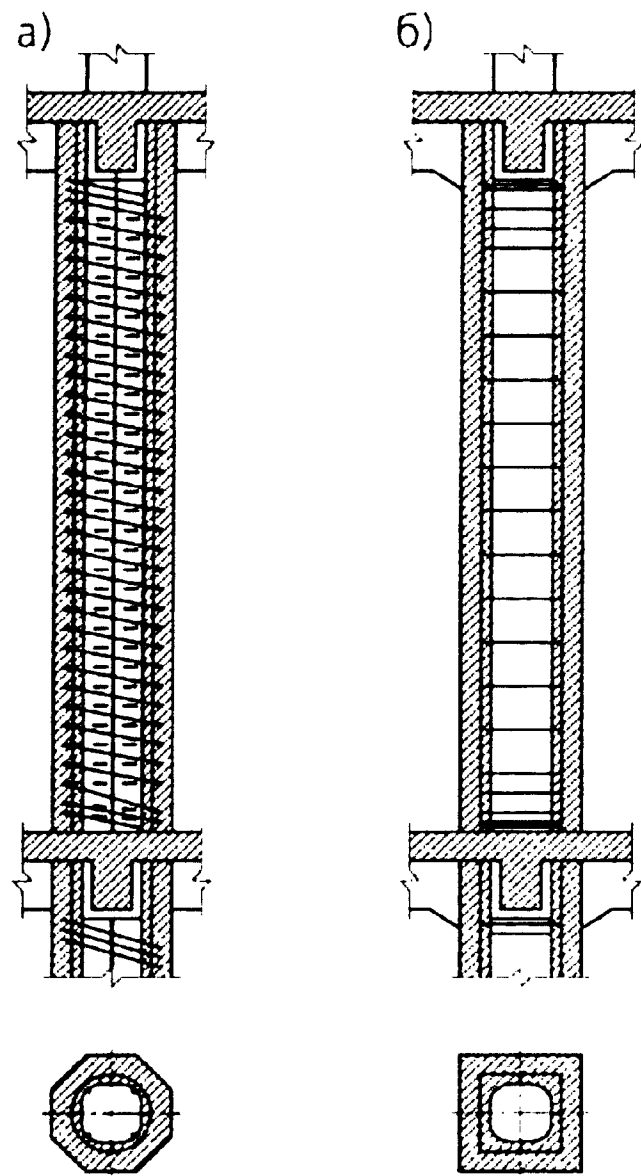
Усиление колонны железобетонной «рубашкой»:
